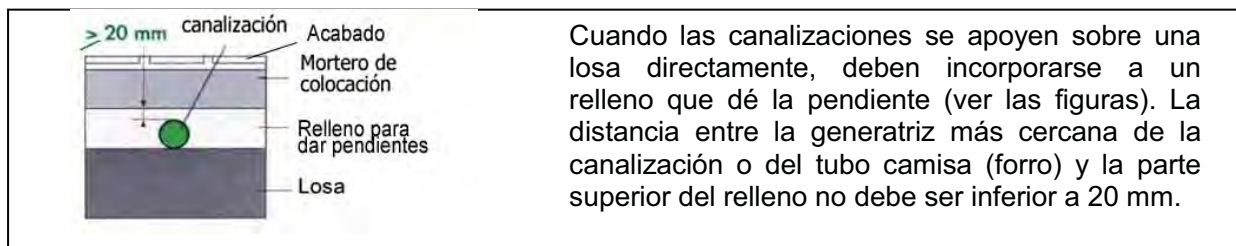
INCORPORACIONES SOBRE LOSAS DE CONCRETO – CASO COMÚN EN LOSAS DE AZOTEAS
